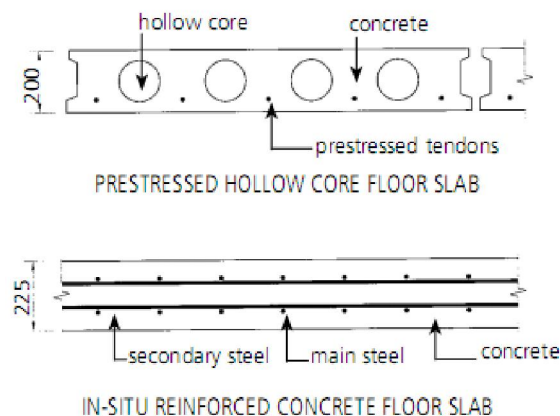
Pormenor construtivo das lajes alveoladas de betão armado do BedZED [41]
